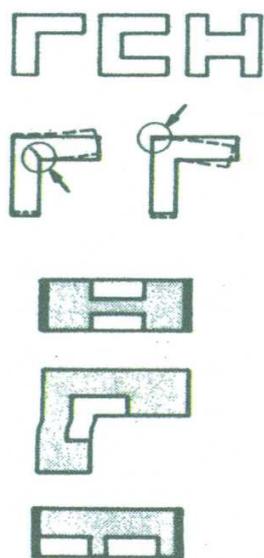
Plantas irregulares en edificios de mampostería (Paulay y Priestley, 1992)
